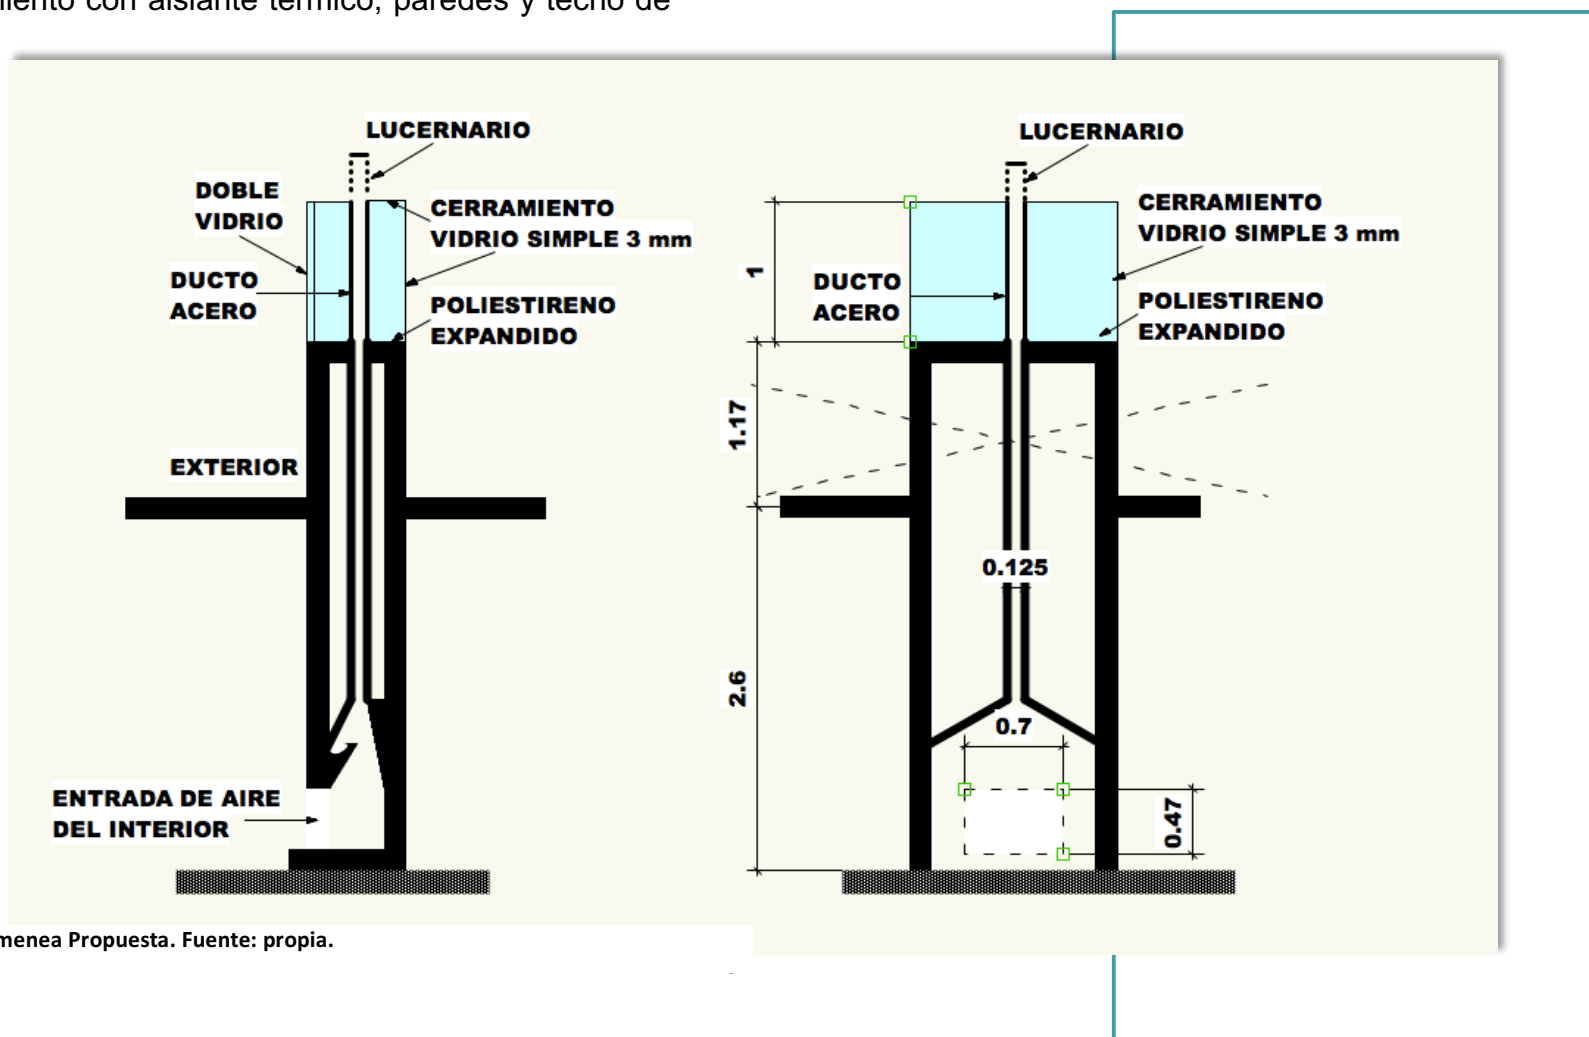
Chimenea Propuesta. Fuente: propia.
